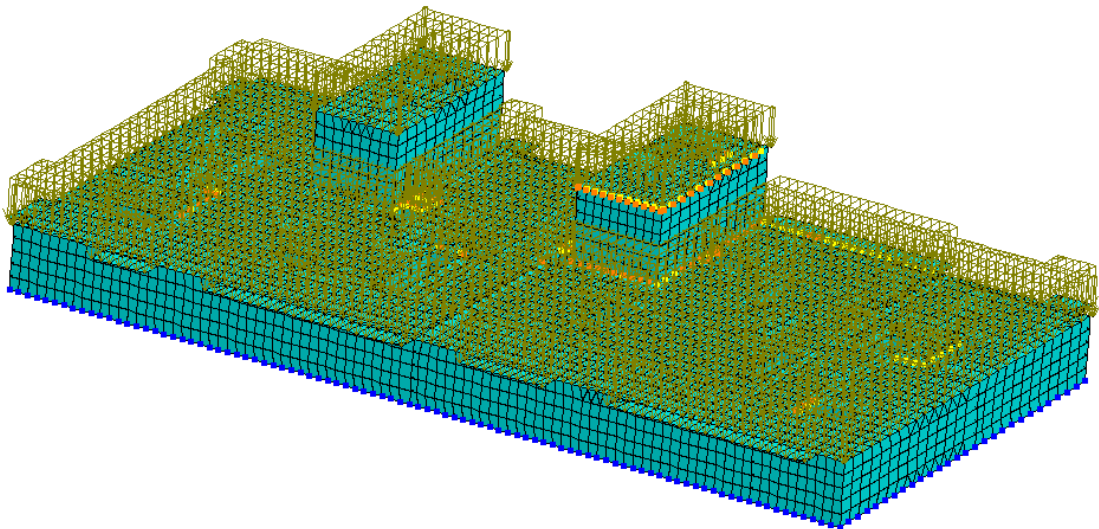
Расчетная схема плиты покрытия со снеговой нагрузкой
